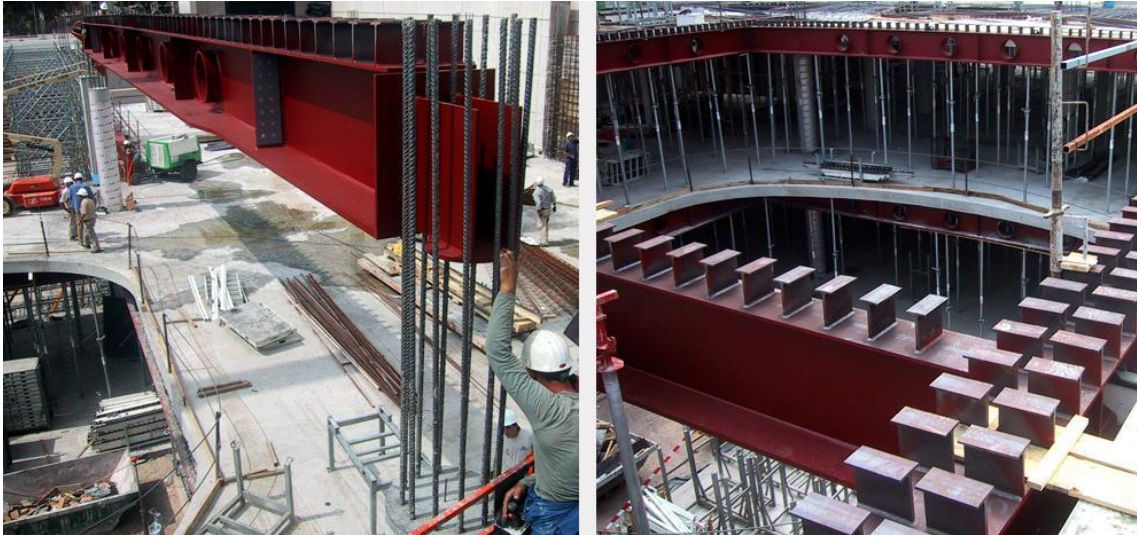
Ejecución de la estructura de acero de la cubierta. Fotografía in situ
